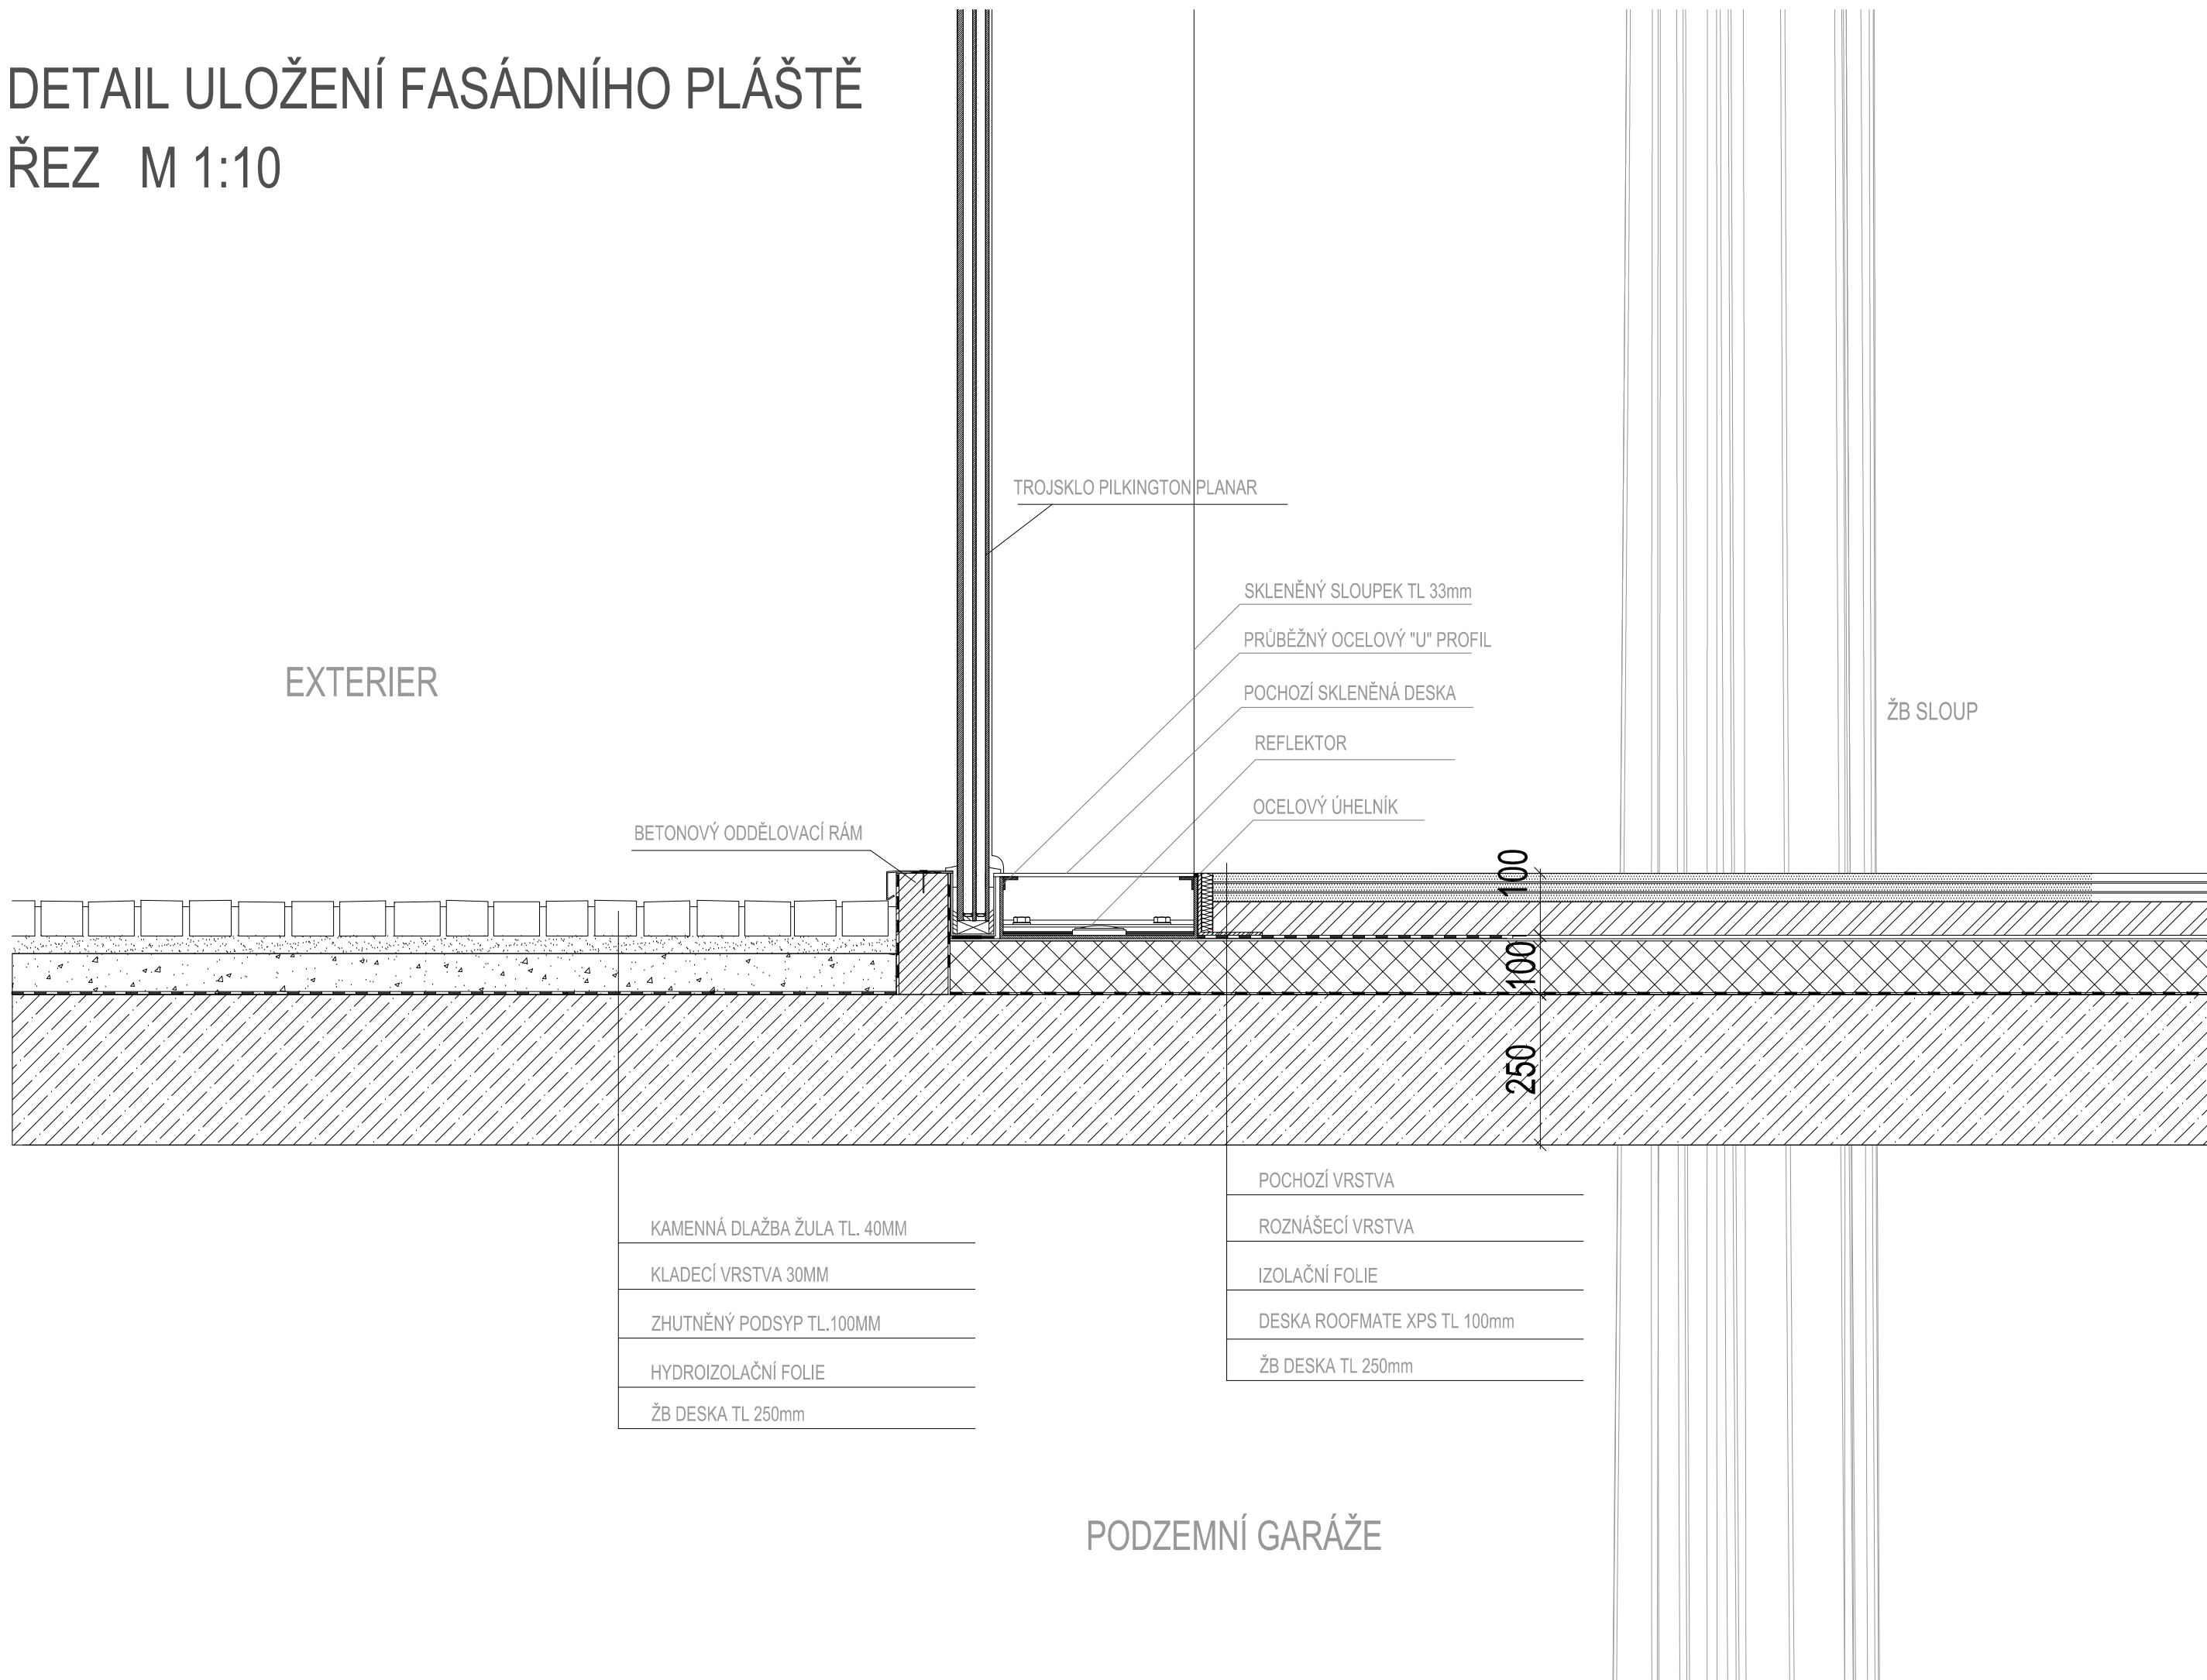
DETAIL FASÁDNÍHO PLÁŠTĚ - ŘEZ M 1:10
